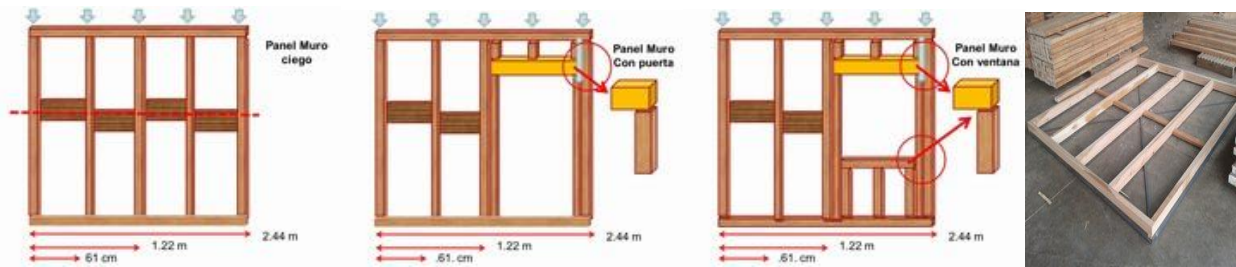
Paneles de muro ciego 2.44 m – puerta – ventana – ejemplo de molde
